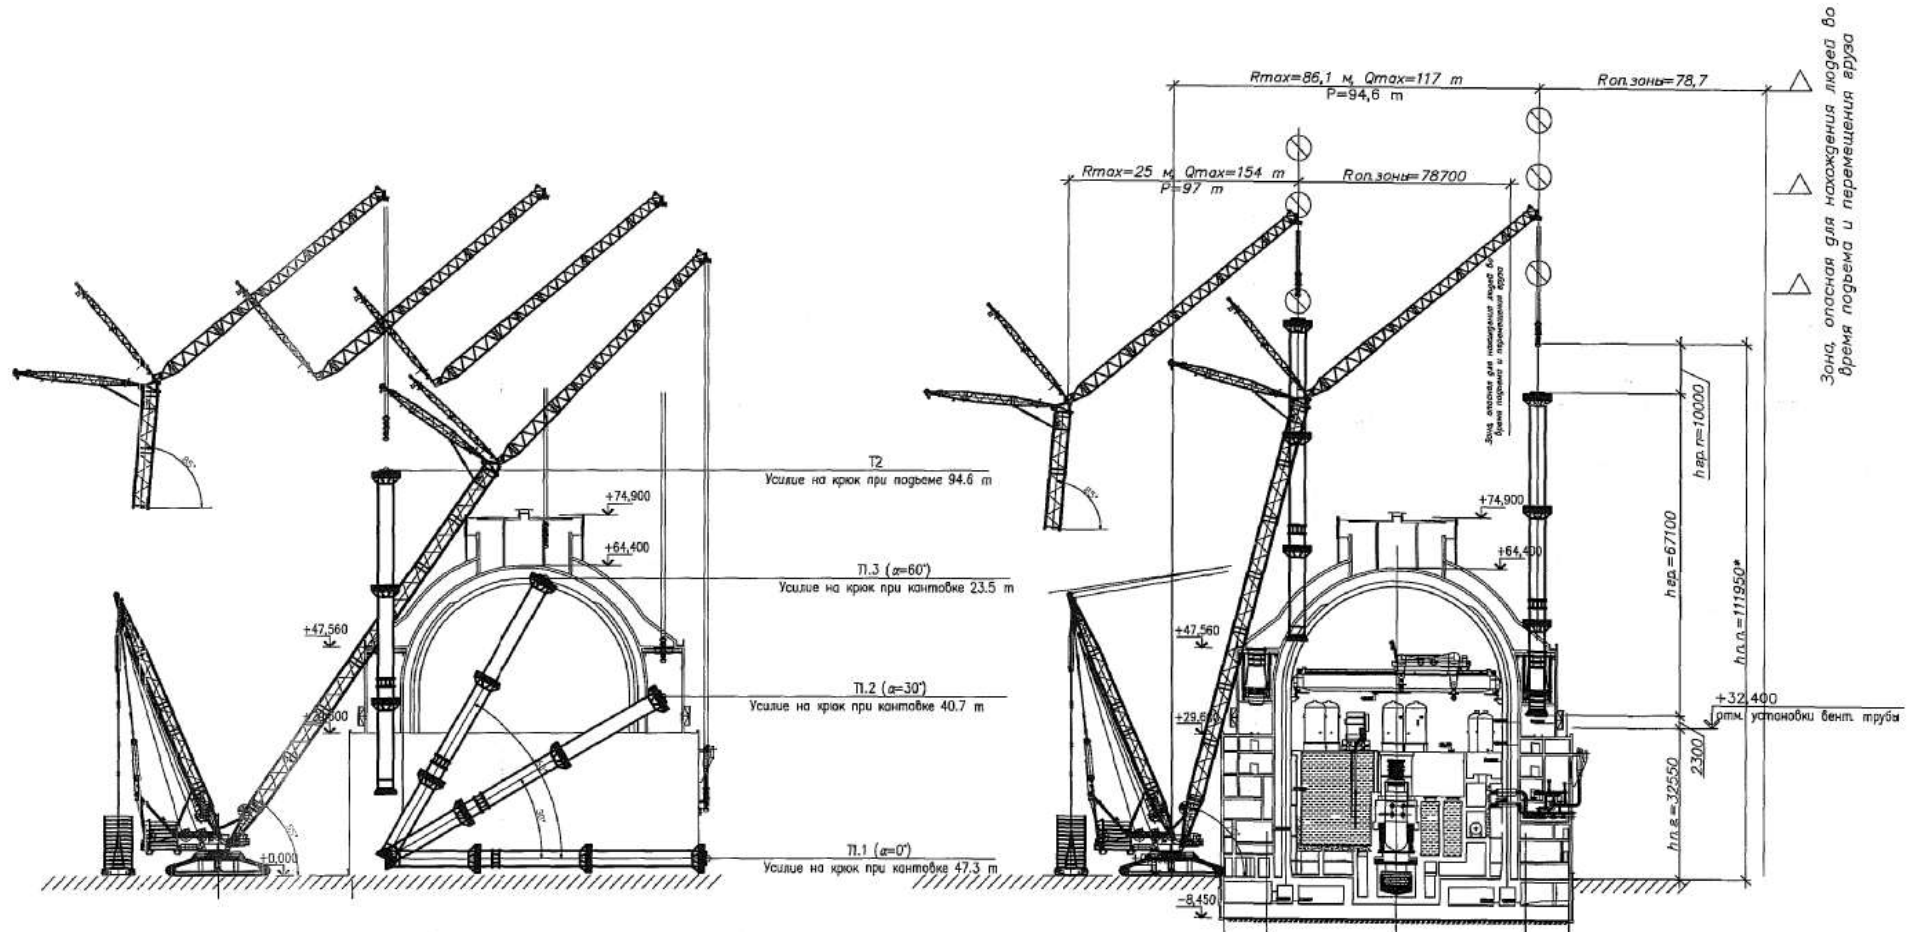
Типовая схема установки блока стальных строительных конструкций вентиляционной трубы
